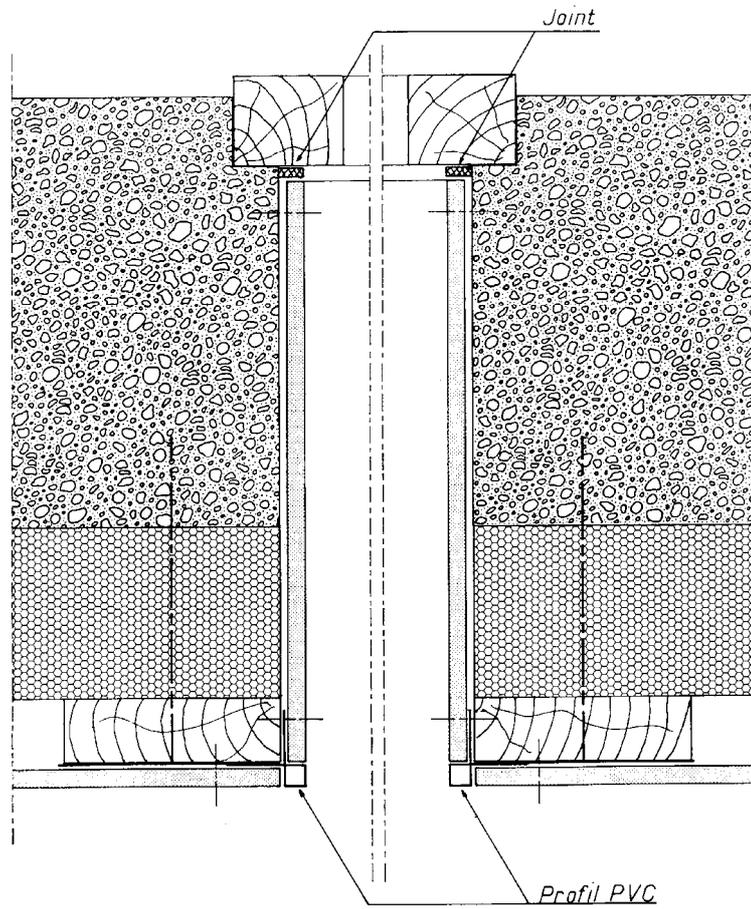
Encadrement de baie sans isolation complémentaire – Coupe horizontale - Pose en vêtage
